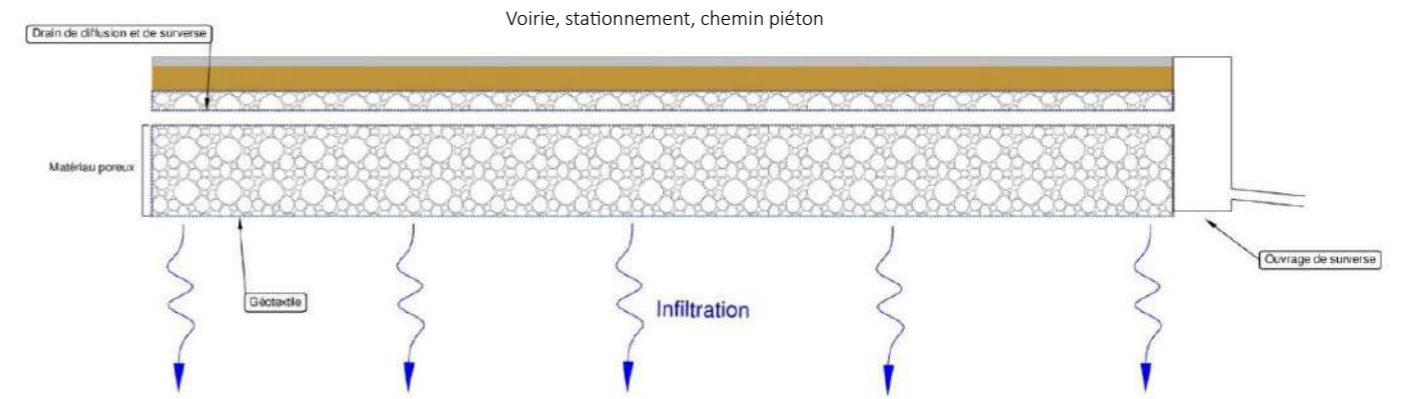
schéma de principe d'un dispositif d'infiltration, type chaussée réservoir - IAO SENN 2024
